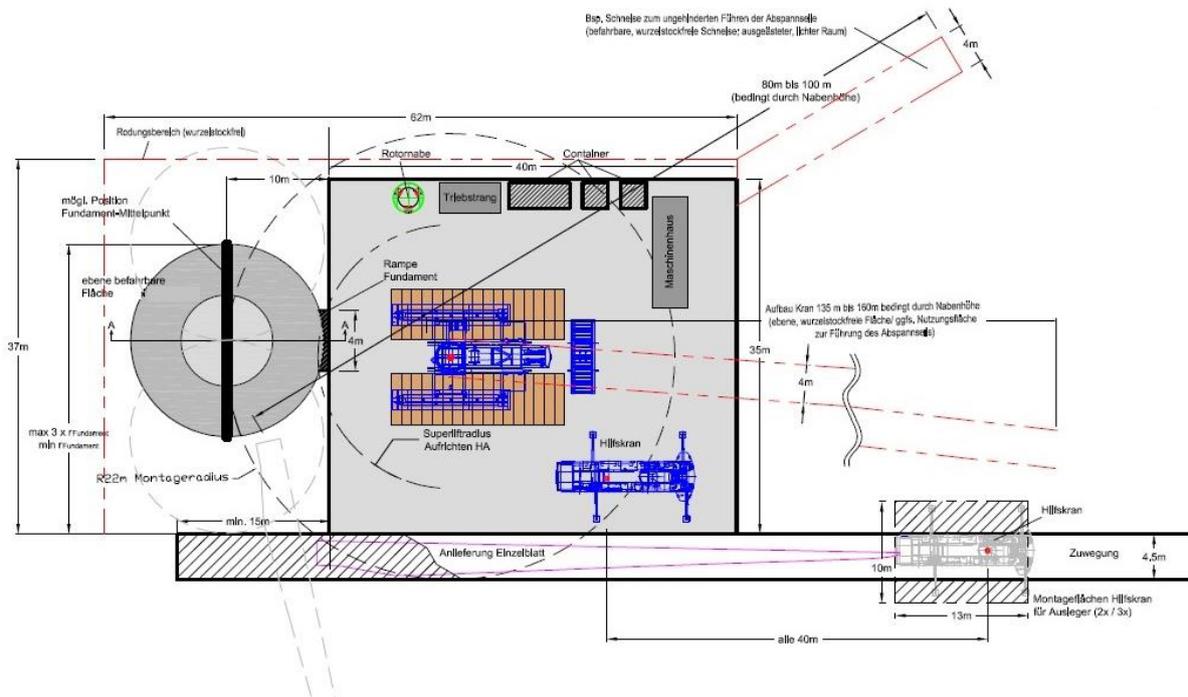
Beispiel einer Stellfläche mit Montage- und Lagerfläche, Aufstellung mit Raupenkran
